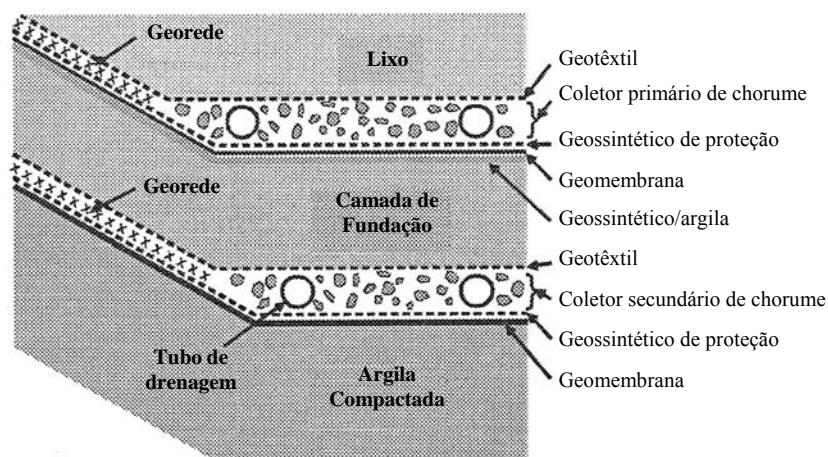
Sistema de drenagem e impermeabilização de aterro sanitário (ROWE, 2005).
